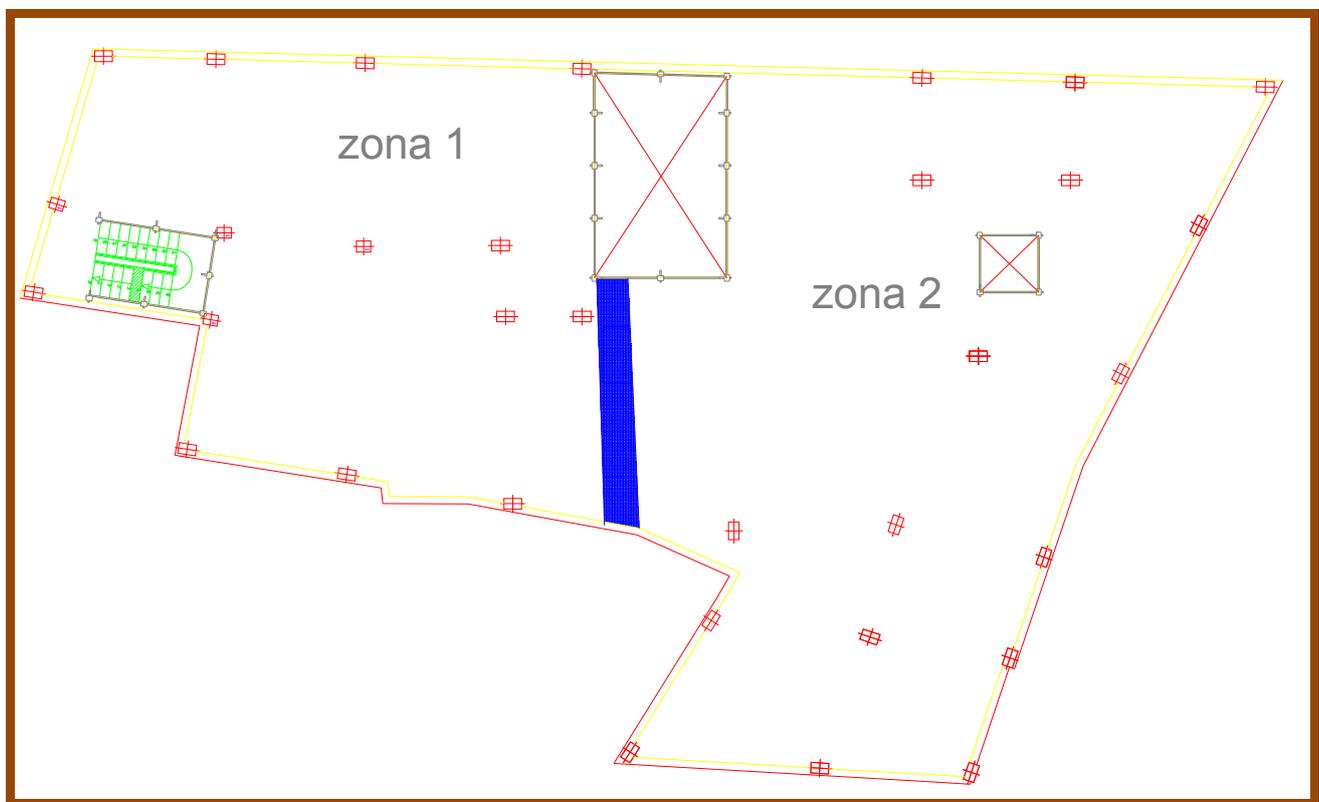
Plano de delimitación de las dos zonas en que se dividió el sótano de fase A, para llevar a cabo los muros del segundo anillo de sótano y la losa de cimentación.
